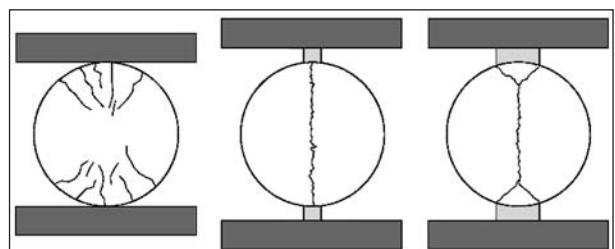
Brucharten beim Spaltzugversuch an Beton nach MITCHELL [68]
